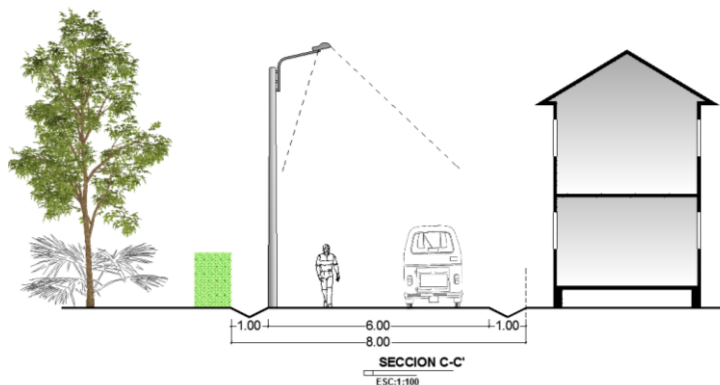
SECCION VIAL DEL BARRIO ENI
